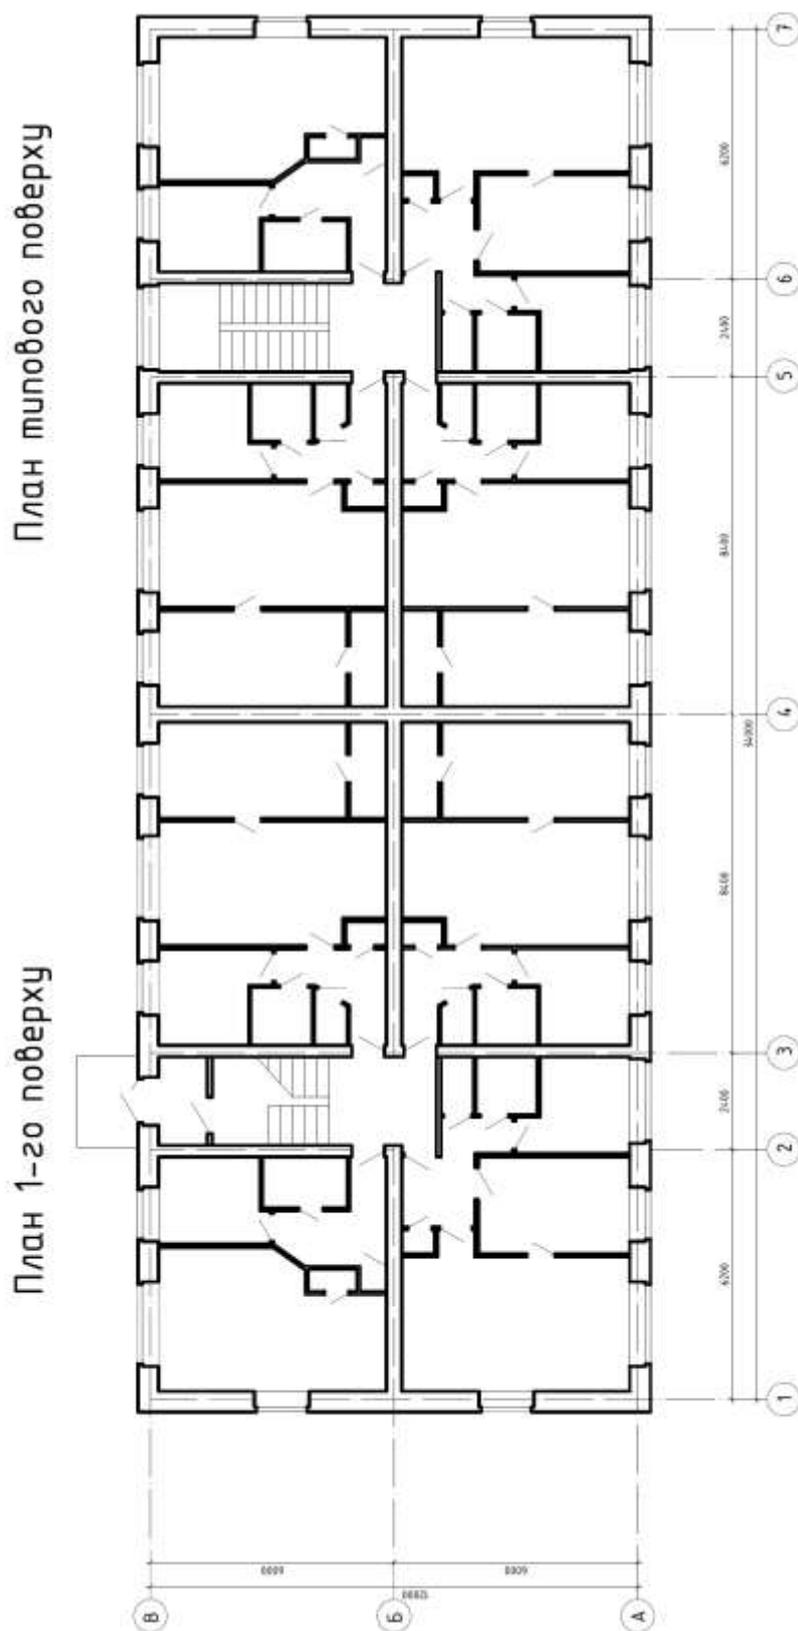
Схема планів першого та типового поверхів житлового п'ятиповерхового будинку до реконструкції.
